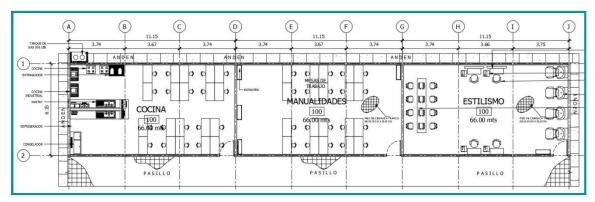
Planta arquitectónica Edificio 3, aulas talleres
